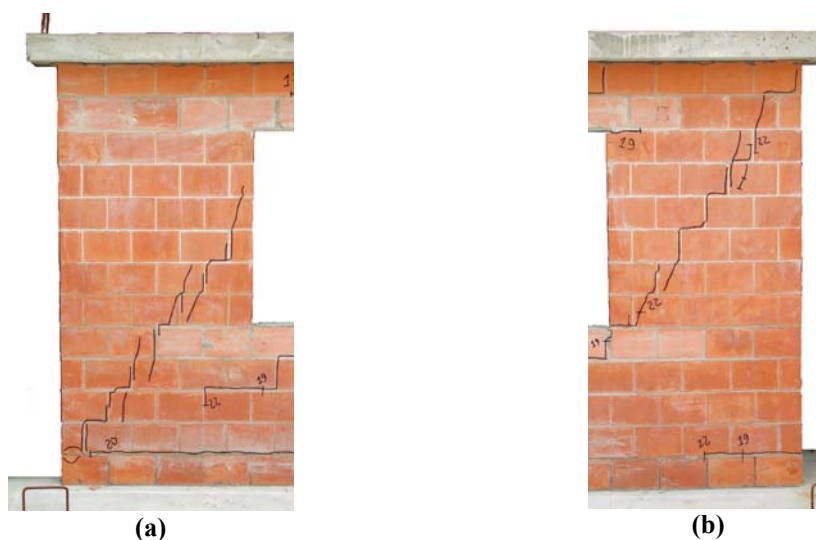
Fissuração das paredes do modelo PJS1: (a) Parede P1 e (b) Parede P2.
